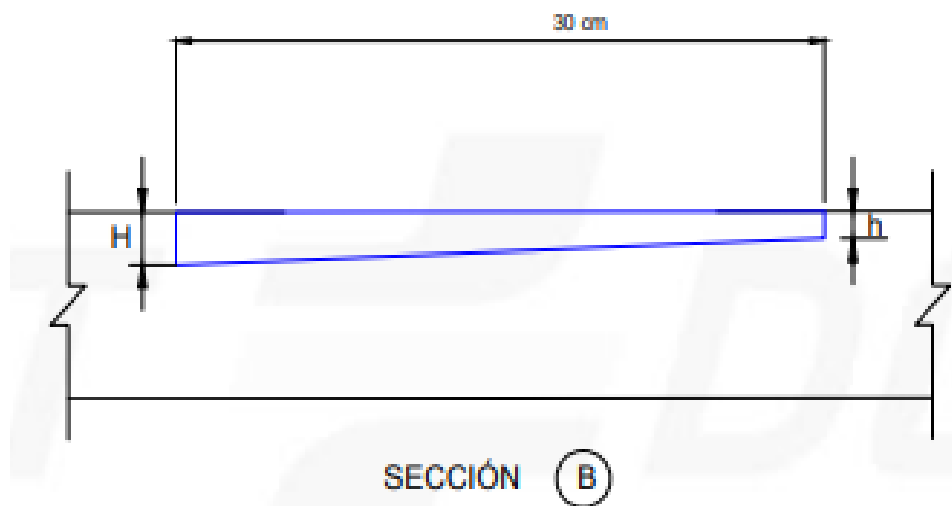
DGT (2018). Sección transversal de guía sonora longitudinal paralelogramo.
